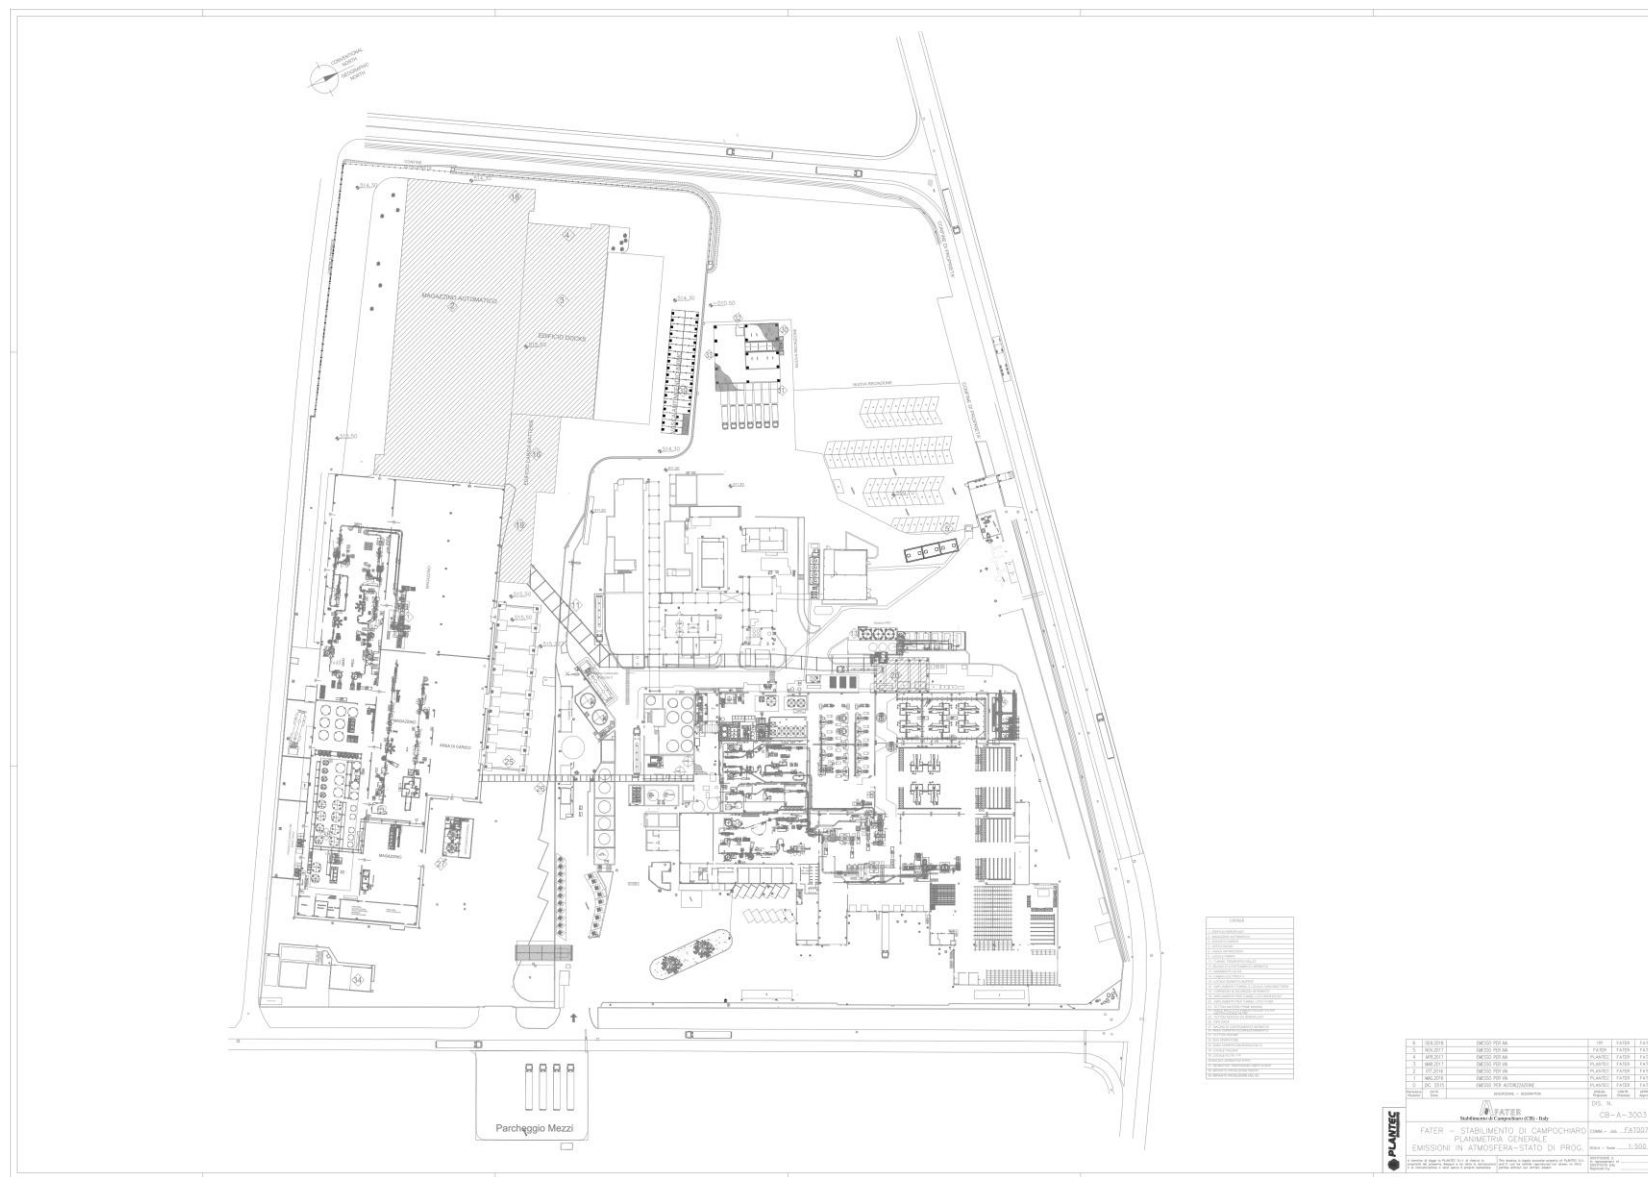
planimetria generale dell'installazione: assetto autorizzato con D.D. della Regione MOLISE n. 3298 dell'08/06/2021
